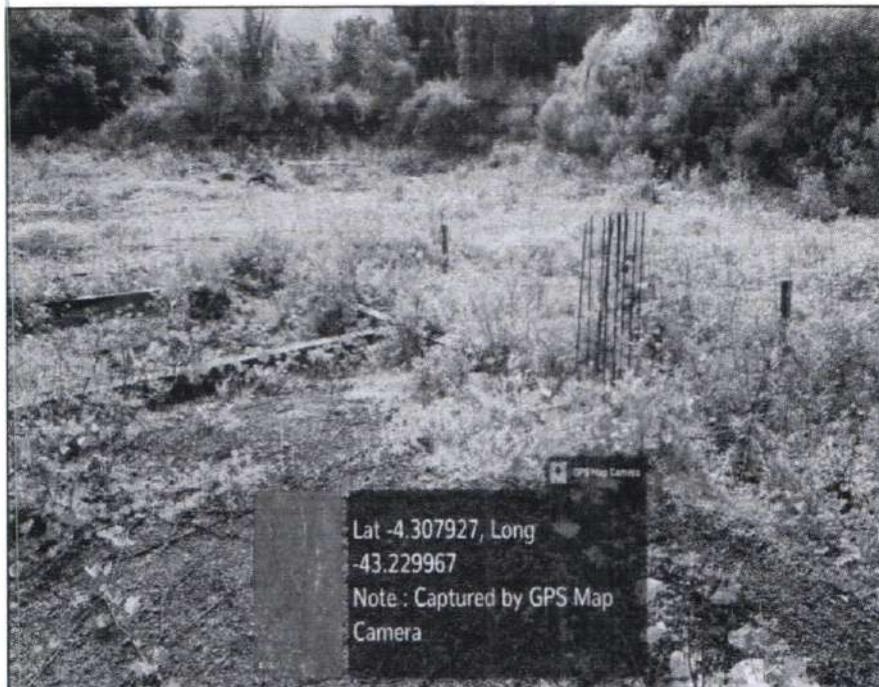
Vigas baldrame encontram-se expostas e sem o aterro previsto executado. Fonte: elaboração própria
